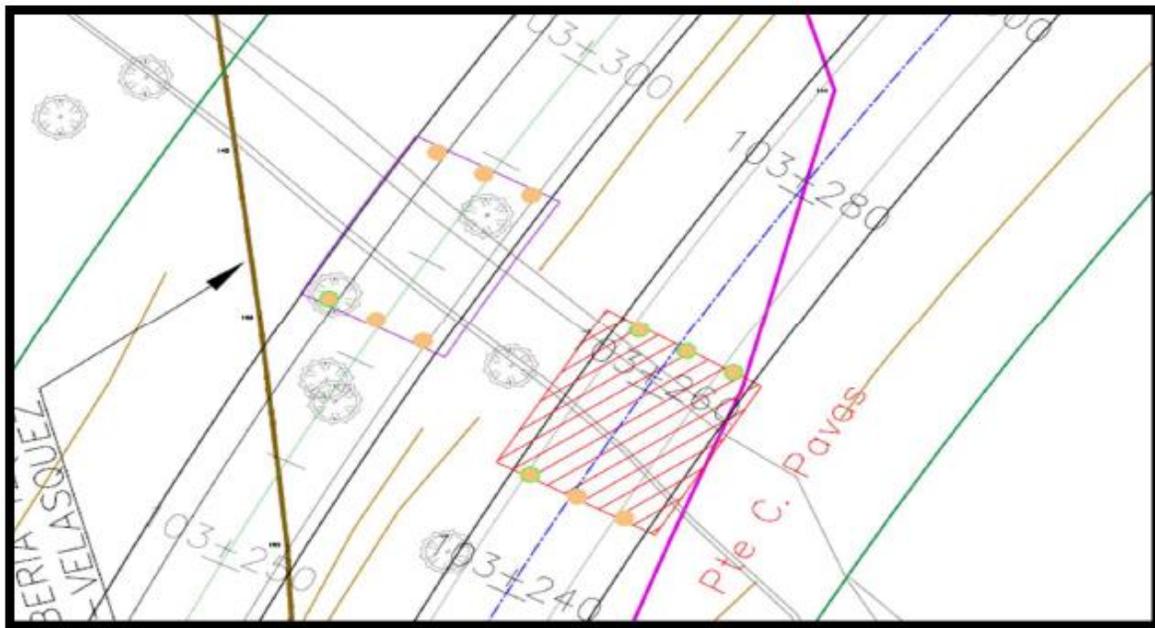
Acercamientos críticos con estructuras viales (Puentes) e infraestructura petrolera
